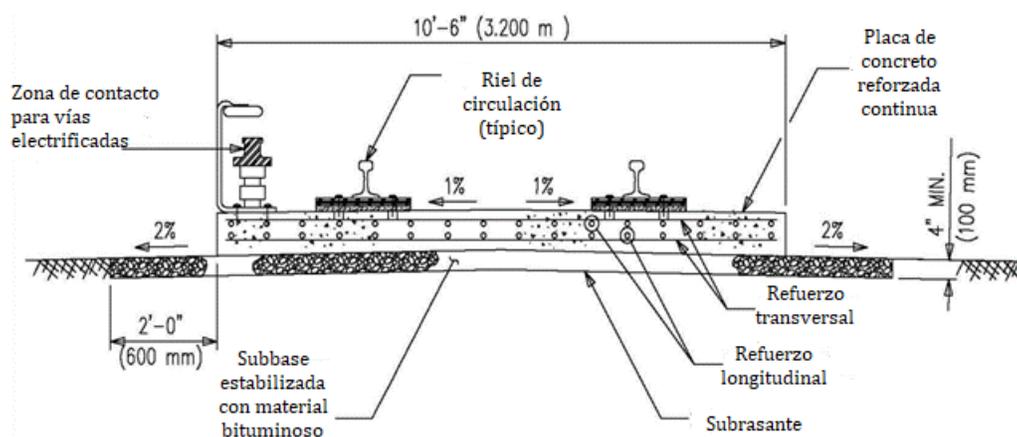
Sistema de vía en placa continua de concreto reforzado (slab track).
